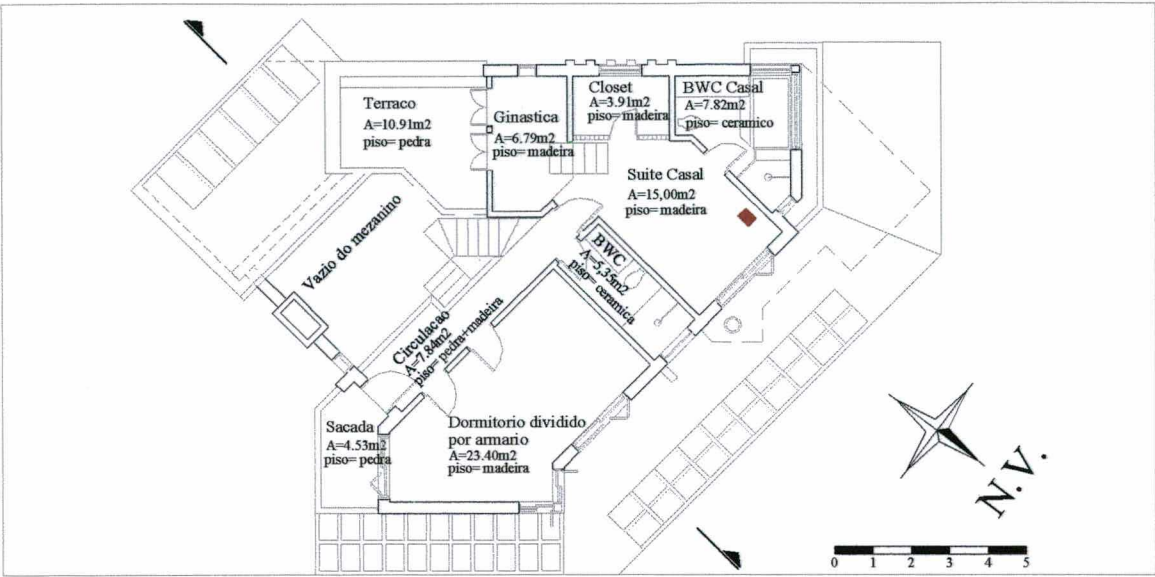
Planta Baixa Pavimento Superior Residência 2
